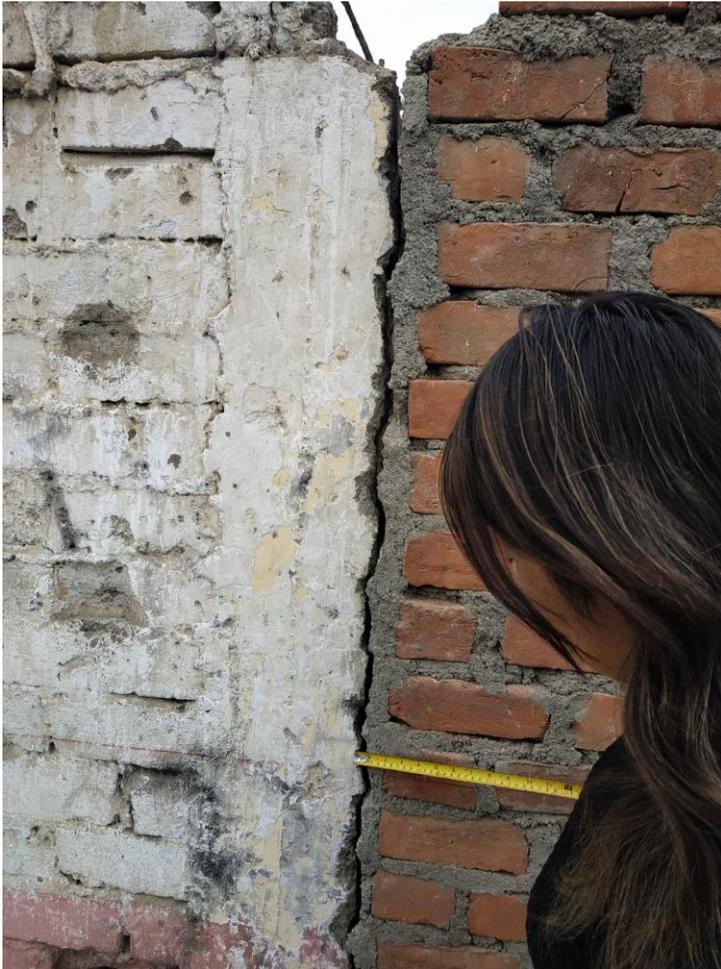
Grietas verticales en unión de columna y muro de la unidad muestral 11, ancho de abertura 0.55 cm con nivel De severidad alto.
